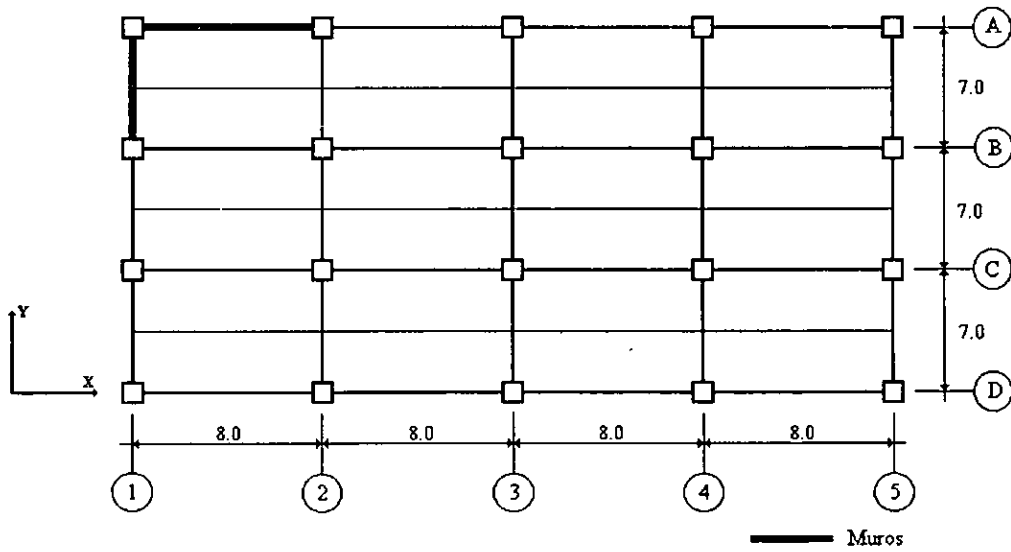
Planta de modelos excéntricos en rigideces, 1 muro en cada dirección.
